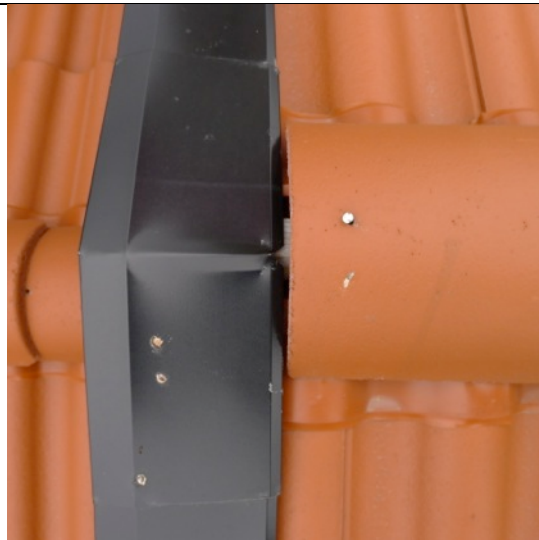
Öppning mellan vattbräda (plåt) och nockpanna.
